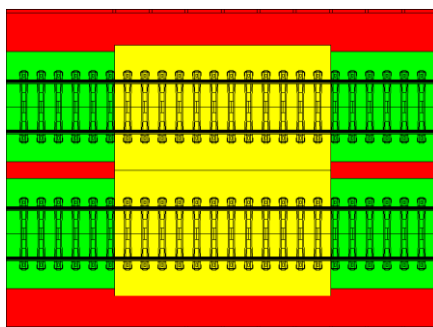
Exemplo das áreas da laje de betão considerada para o cálculo das armaduras longitudinais na plataforma ferroviária
